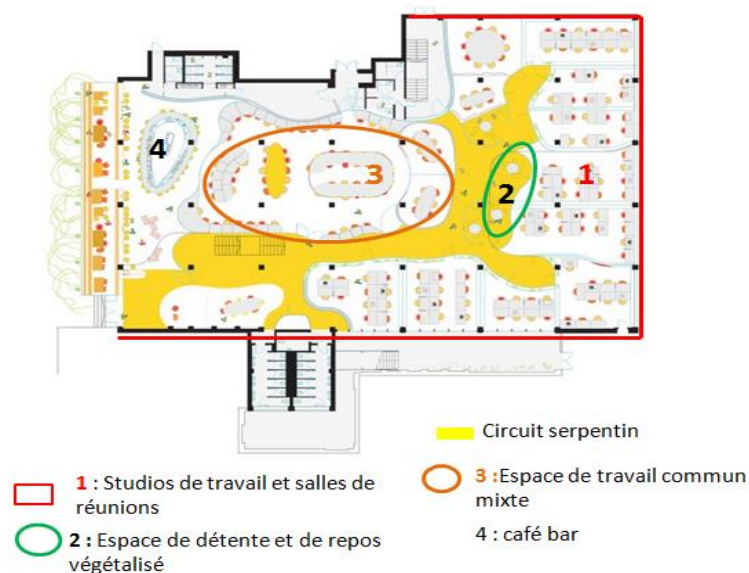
Analyse fonctionnelle Plan rez-de-chaussée
